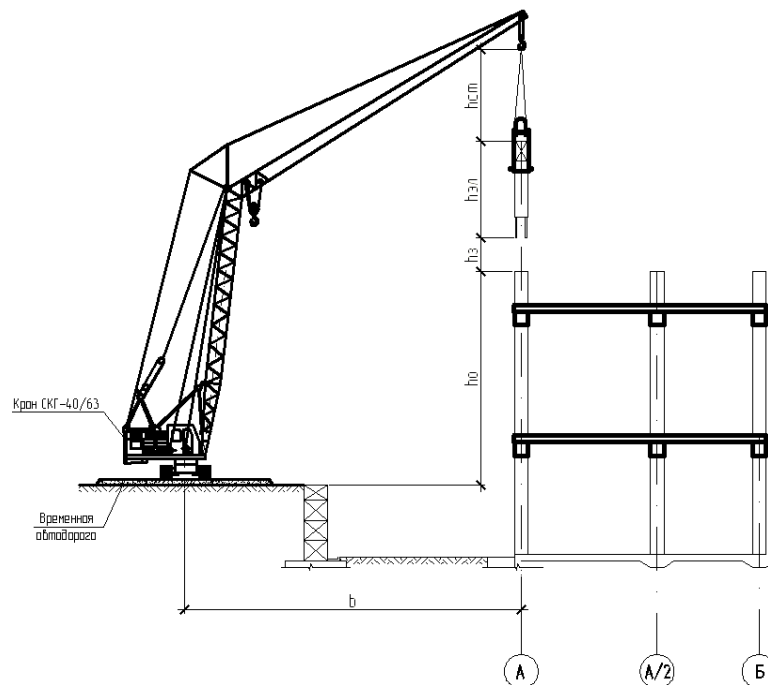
Расчетная схема к определению основных монтажных параметров гусеничного крана
